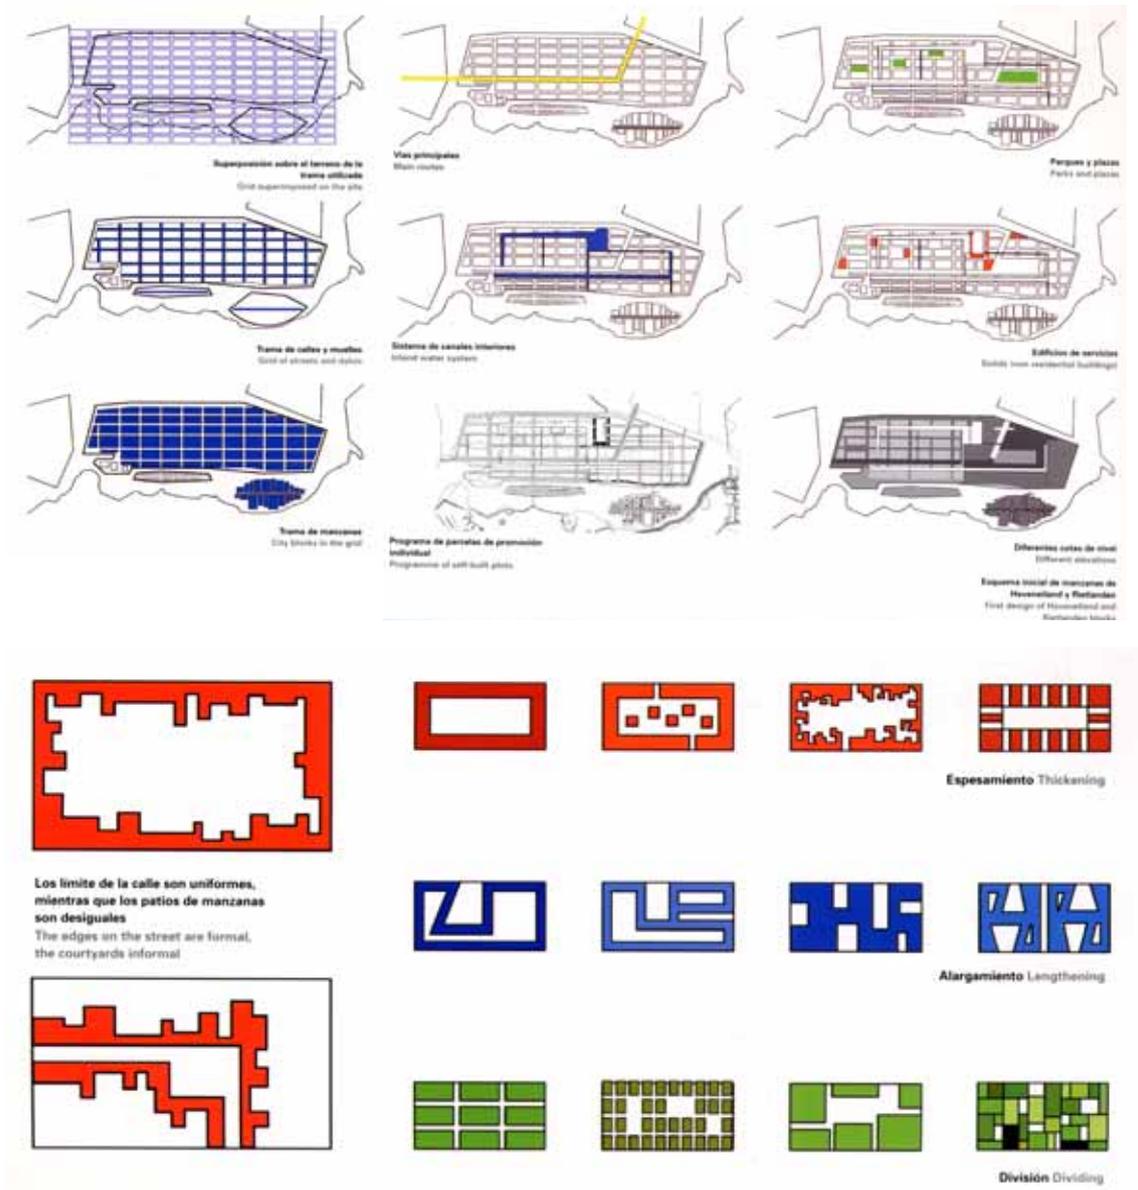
Plano para Haveneiland, IJburg, Amsterdam – Arqs. Claus, Van Dongen, Schaap – Plantas esquemáticas do plano (acima) e estratégias de ocupação dos quarteirões (abaixo).
